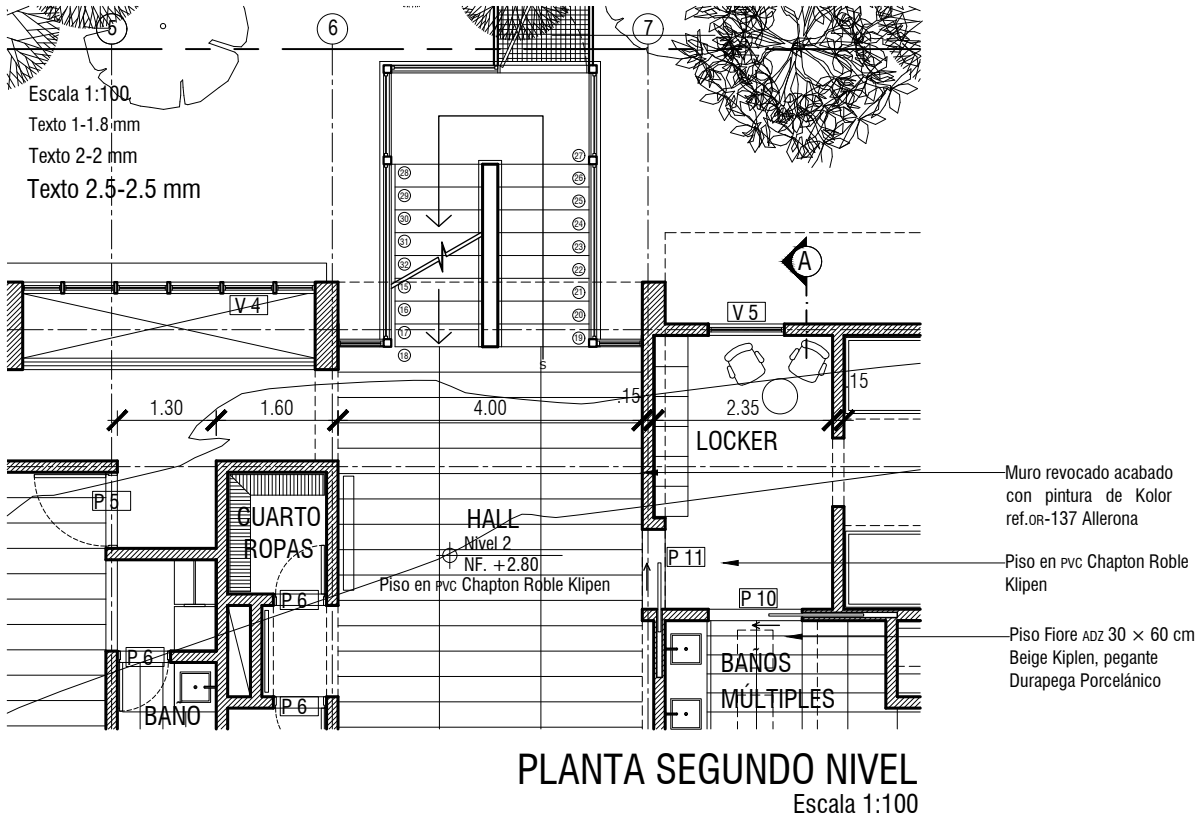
Representación de textos del grupo 1 dentro de una planta arquitectónica
